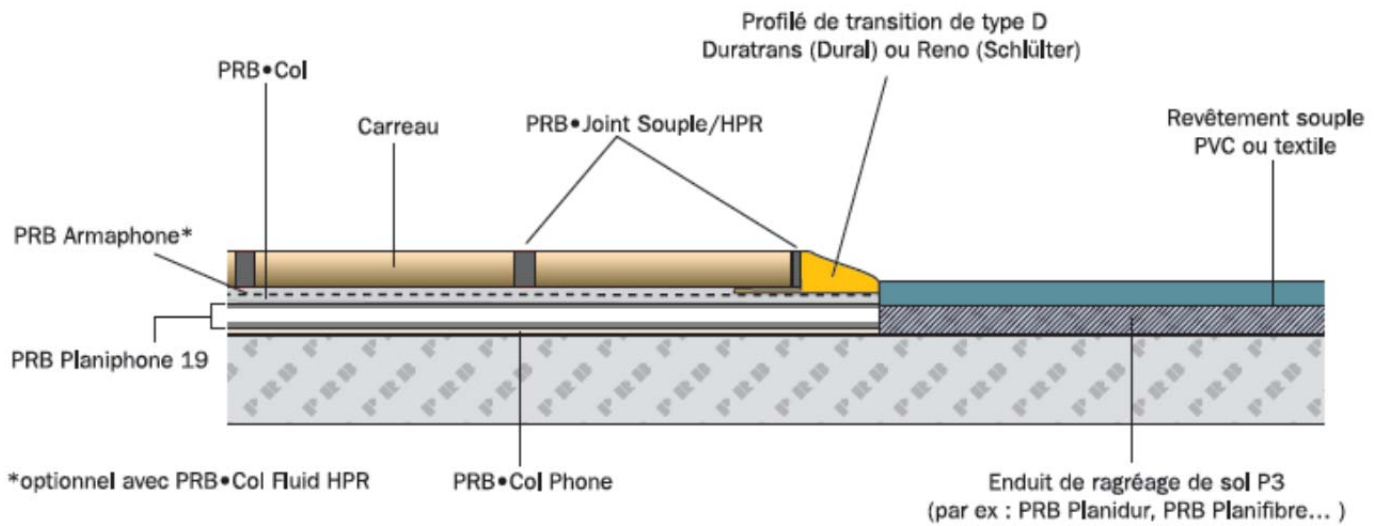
Traitement d'un raccord entre le système PRB PLANIPHONE 19 et un revêtement de sol souple
